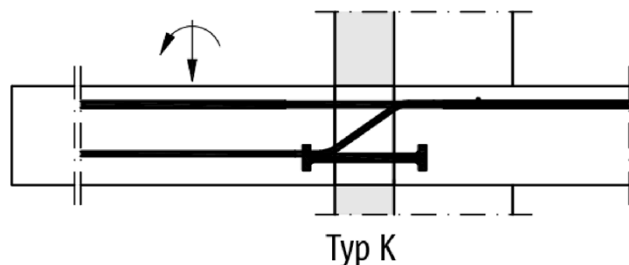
Schöck Isokorb® Typ K, K-F (Variante mehrteilig) für frei auskragende Balkone mit Stahldrucklager mit angeschweißten Druckplatten
